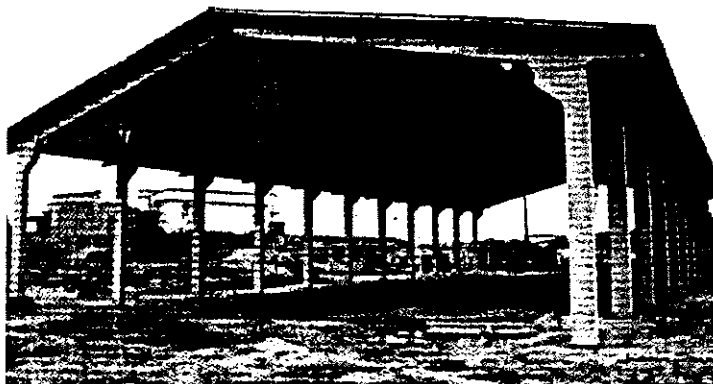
Sistema estrutural de pórticos para telhado de duas águas.
